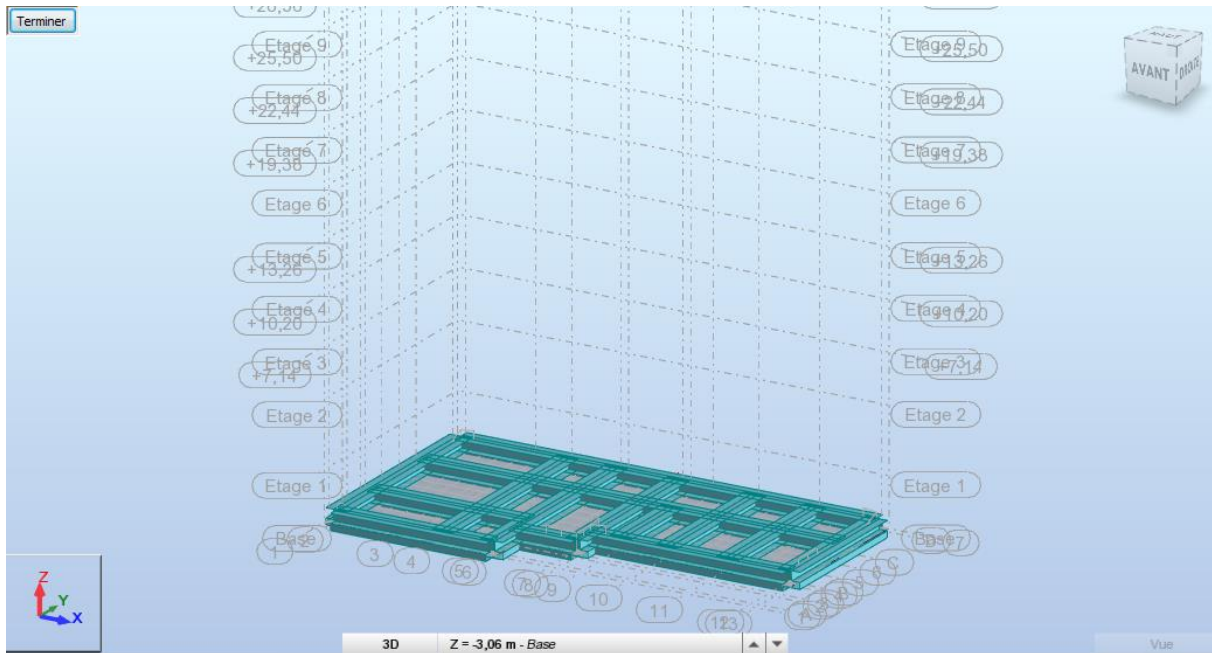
modélisation du radier et les poutres radiers en 3D
